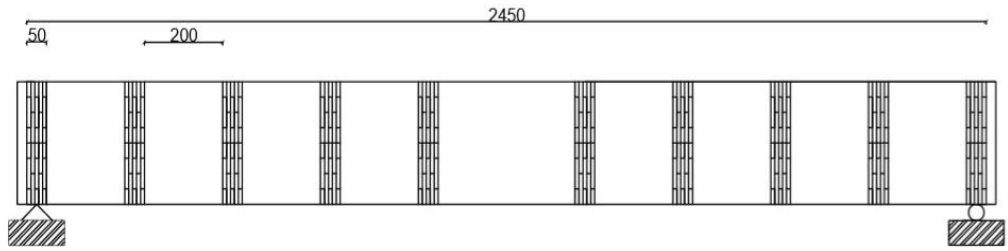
1 nolu deney elemanı donatı detayı.
